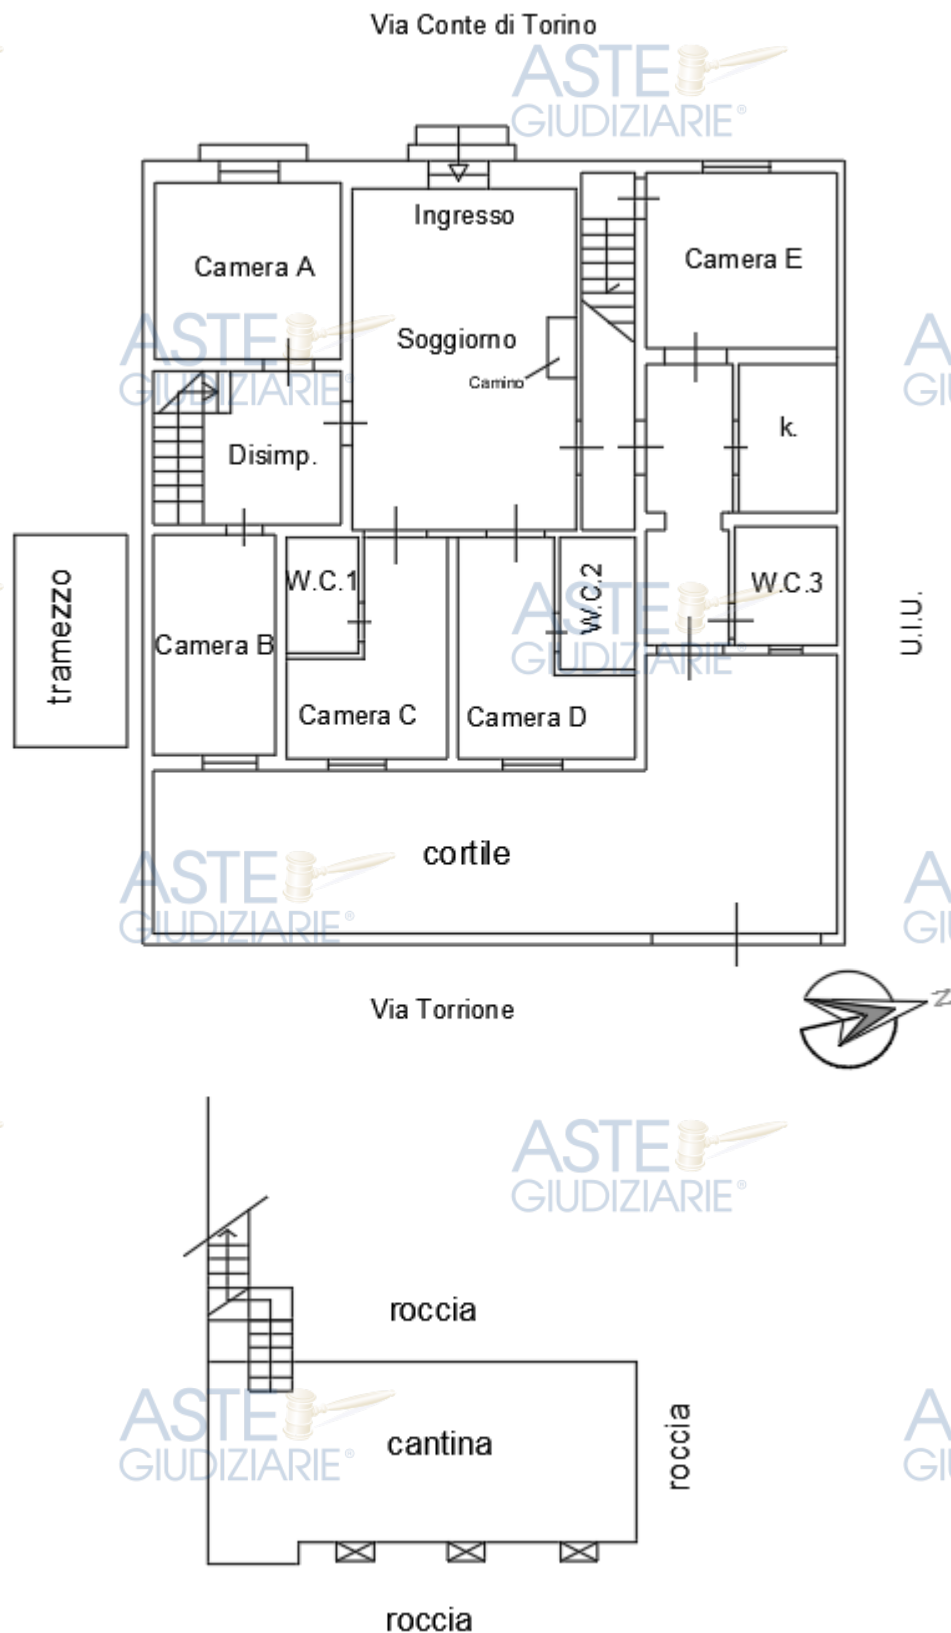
Rappresentazione in pianta piano terra e piano seminterrato
